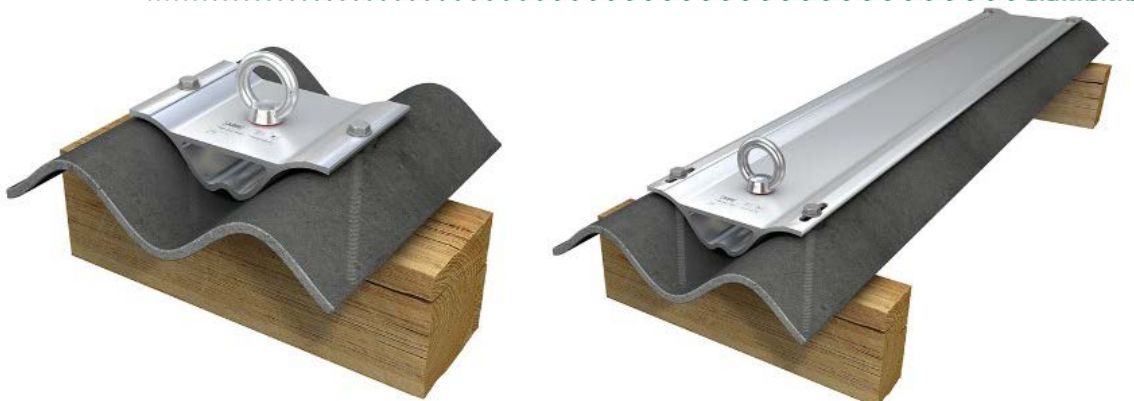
2 : Dispositif d'ancrage, type : ABS-Lock® Wave (exemple de montage)
